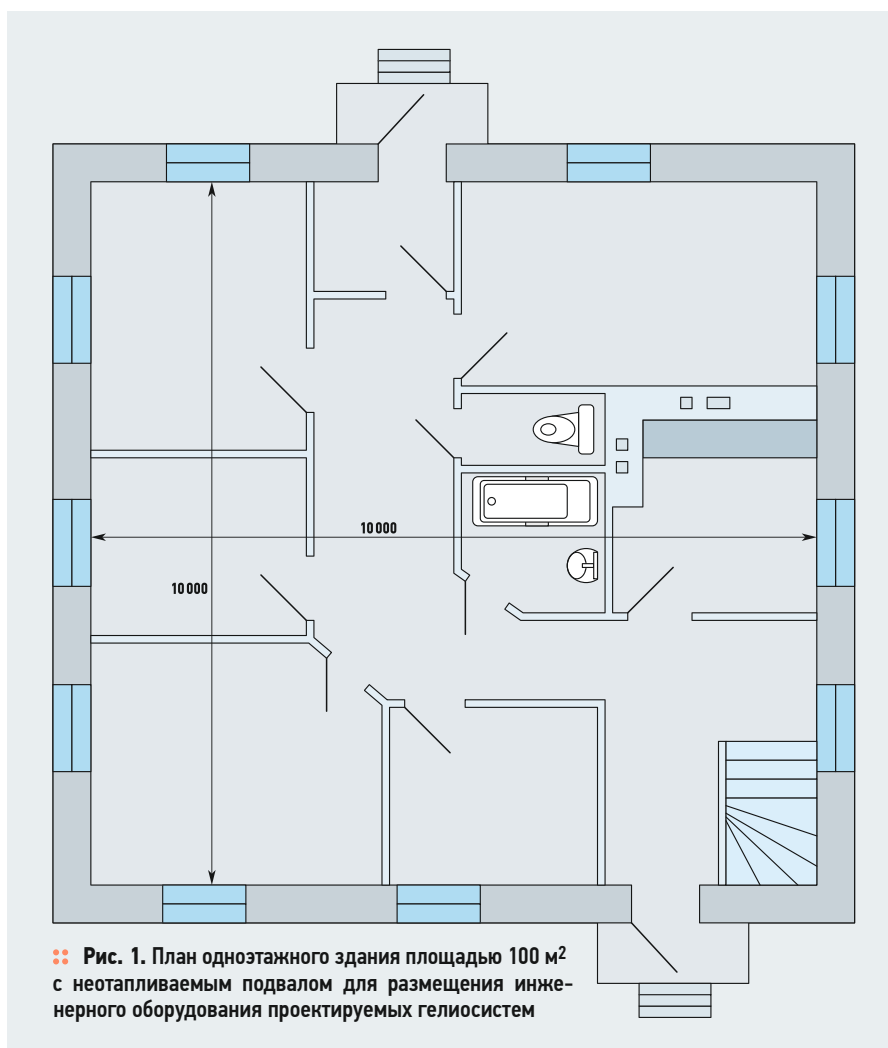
План одноэтажного здания площадью 100 м<sup>2</sup> с неотапливаемым подвалом для размещения инженерного оборудования проектируемых гелиосистем
